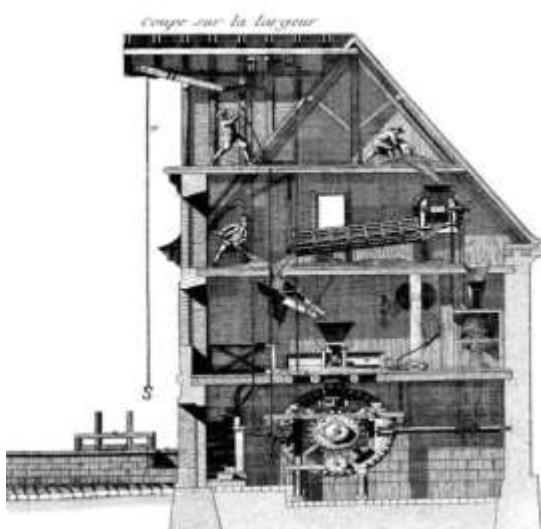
Engrenages de la conversion de l'énergie hydraulique en énergie mécanique
